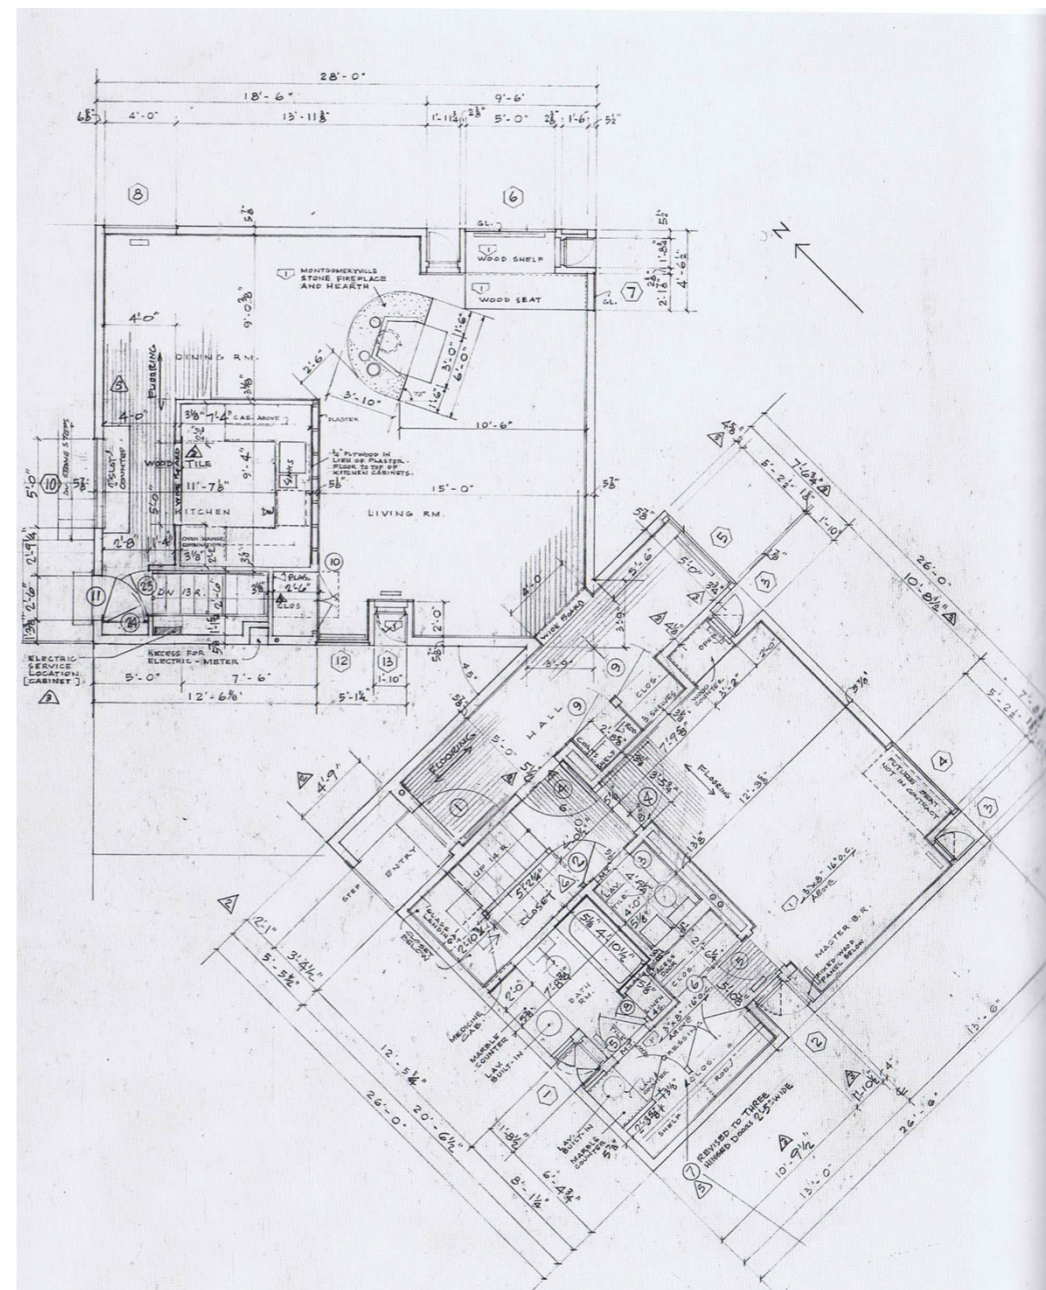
Louis, K., (1964) Planos original de la planta de entrada principal ejecutados a mano de la Fisher House.
